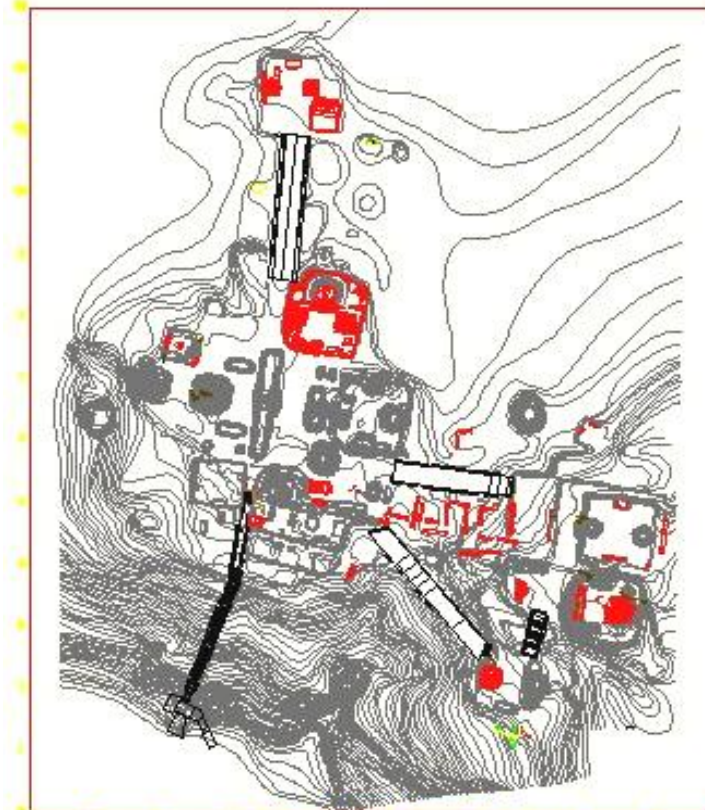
PLANTA 2D DE TERCERA ETAPA CONSTRUCTIVA DE CALZADAS.
